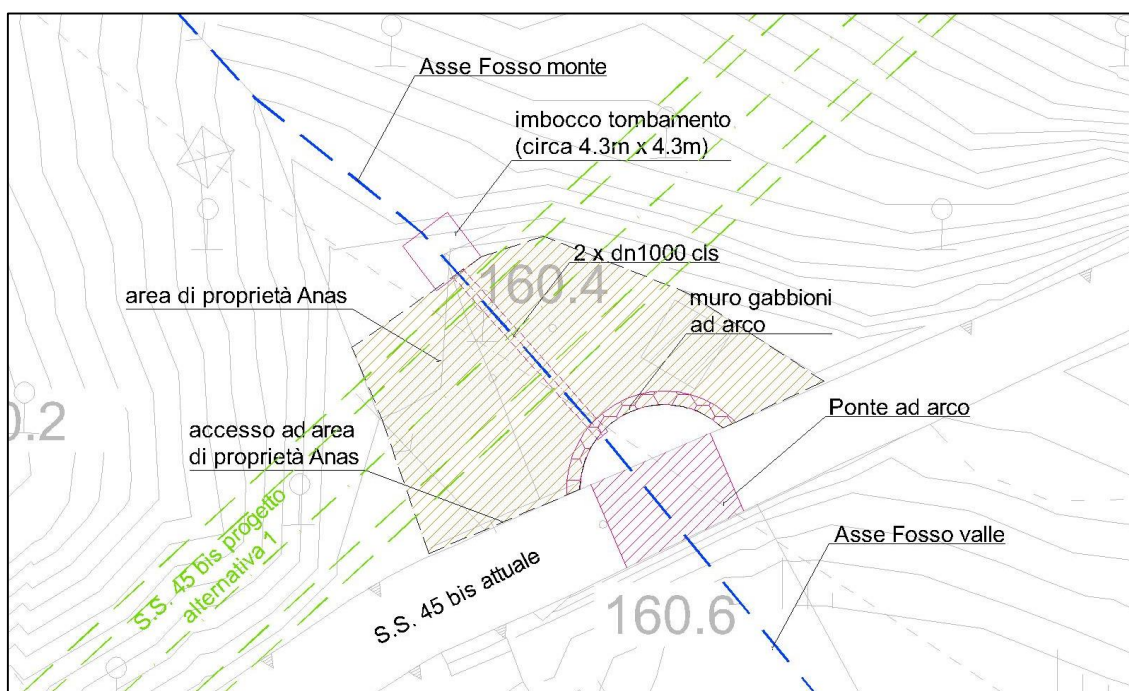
Ricostruzione attraversamento attuale sotto la SS45 bis - pianta
